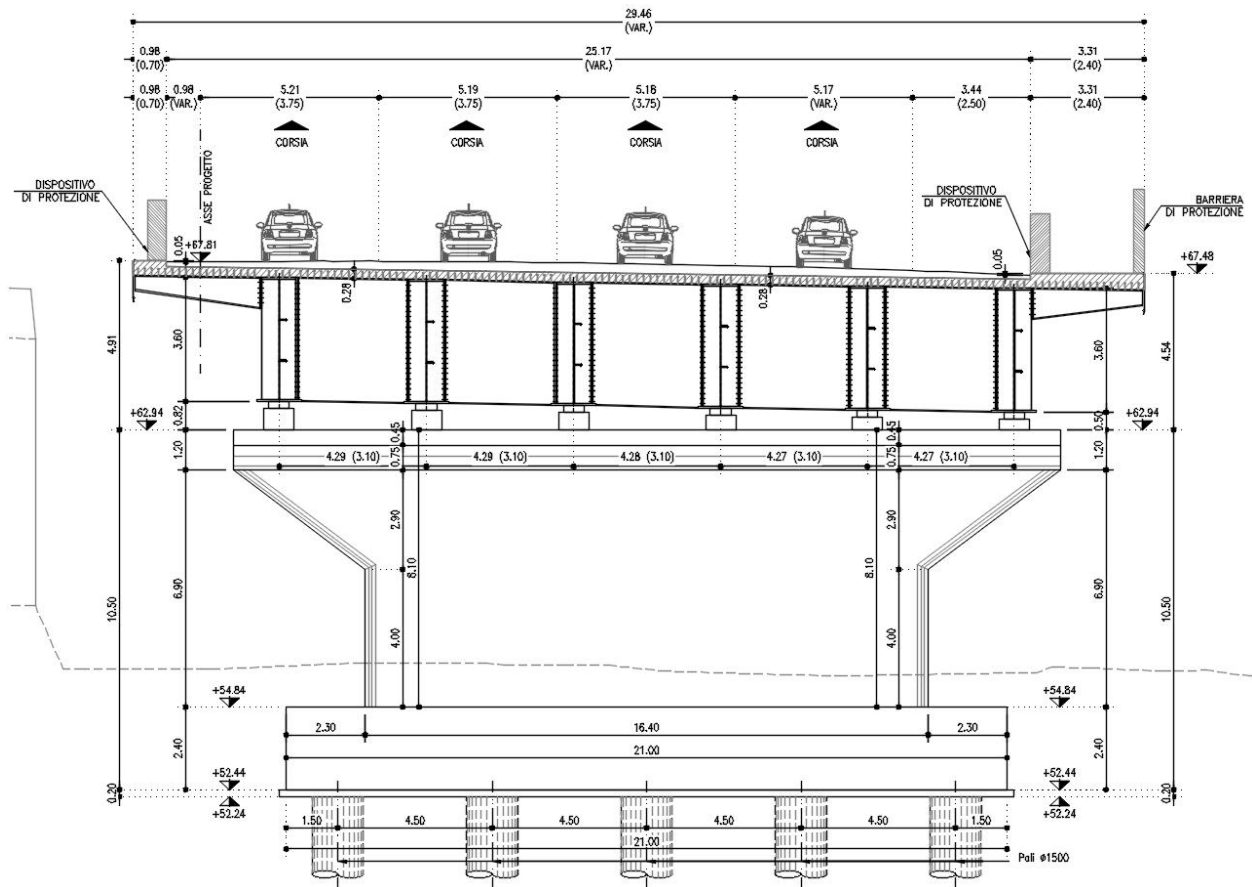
Pila a mensola - Sezione trasversale Pila P2
